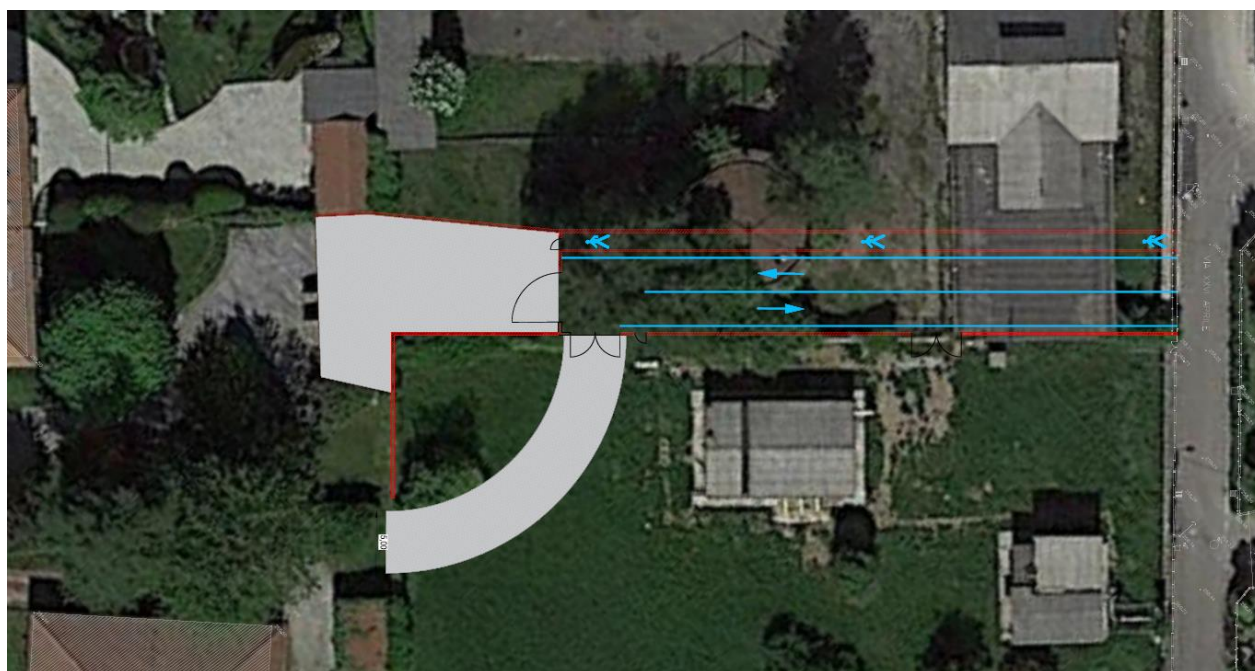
Planimetria di progetto nuova viabilità accesso privati
